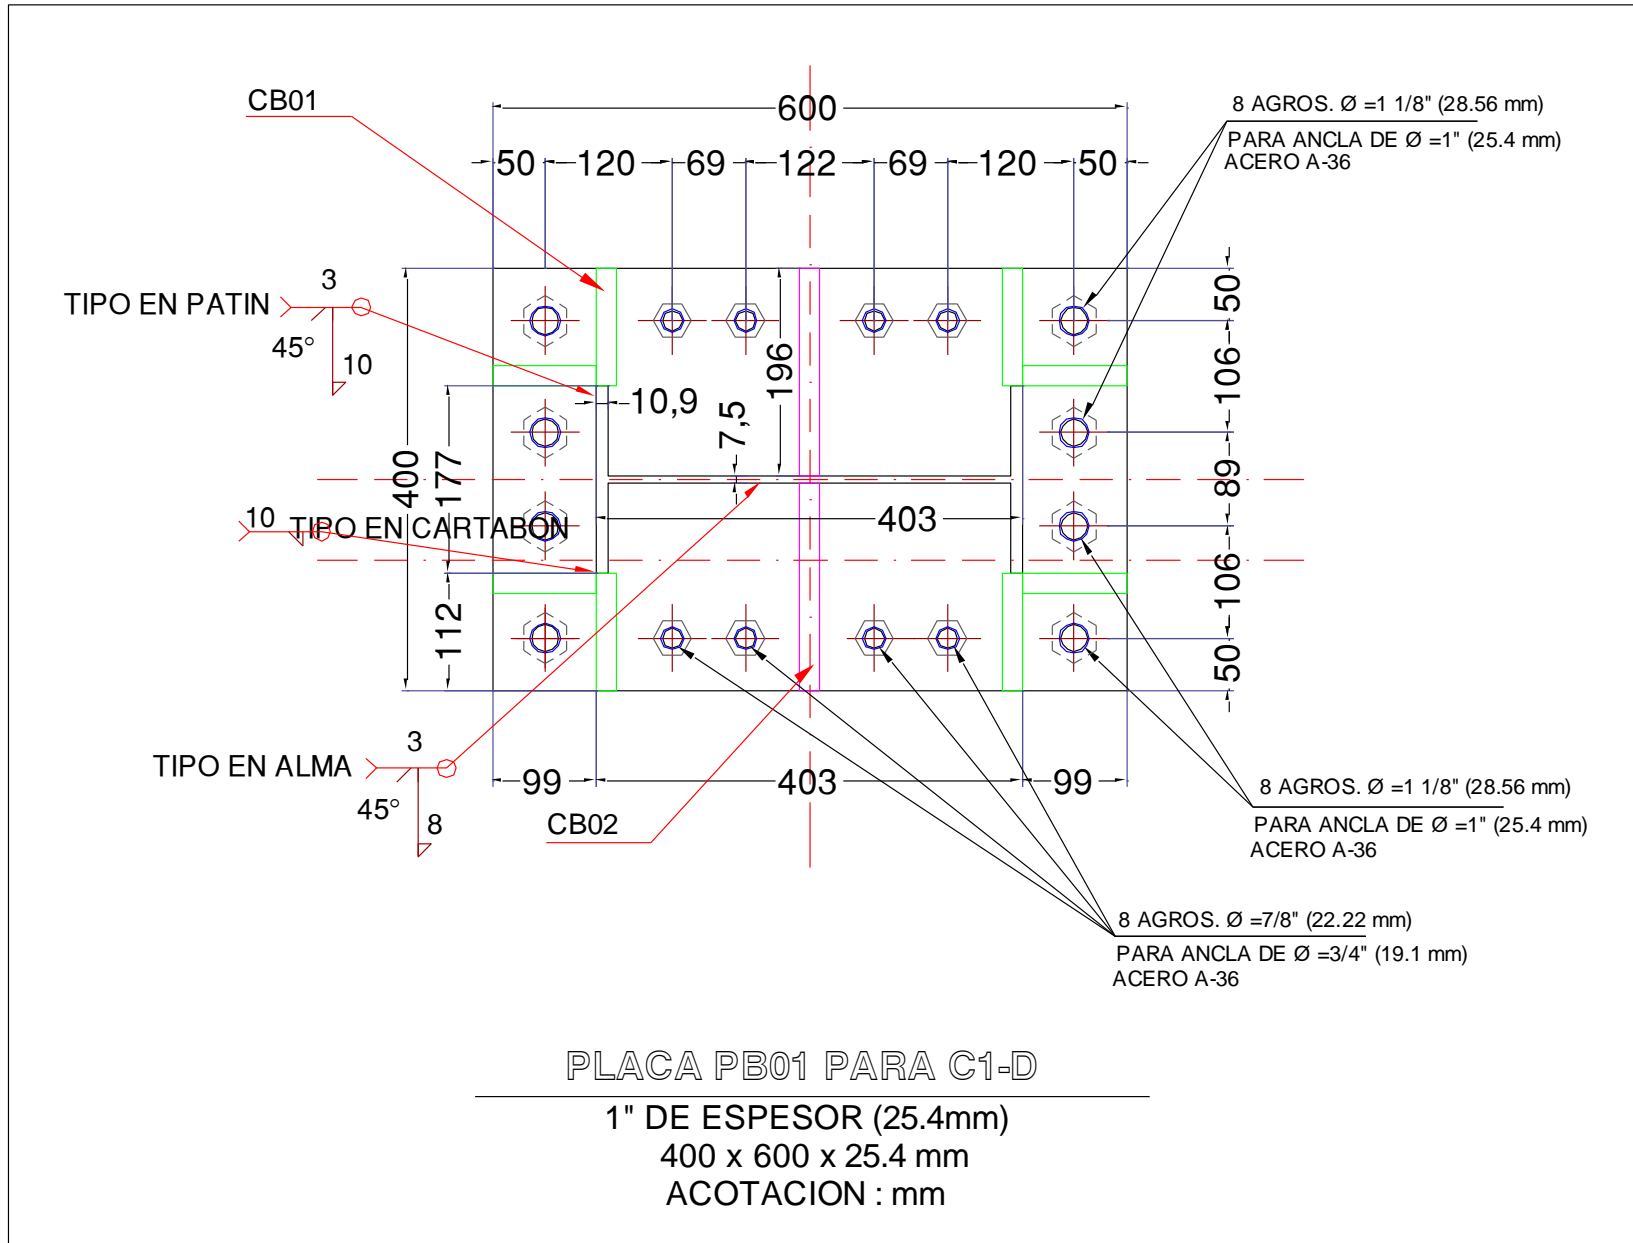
Detalle de Planos de Taller (Placa Base)
